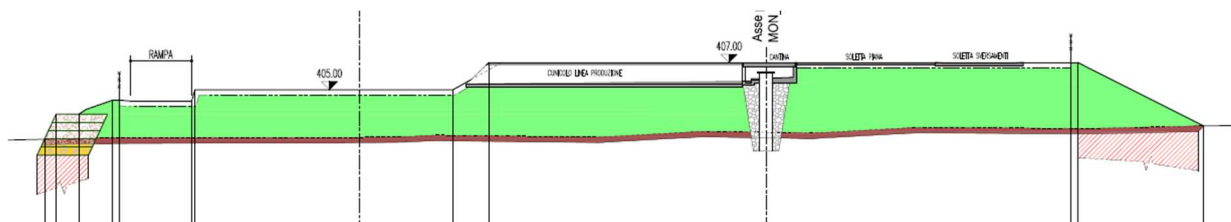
Sezione trasversale della piazzola con evidenza del rilevato artificiale (in colore verde), delle terre rinforzate (a sinistra) e del rilevato semplice (a destra) con trattamento jet-grouting alla base (da elaborato di progetto GRE.EEC.D28.IT.G.13405.00.034).
